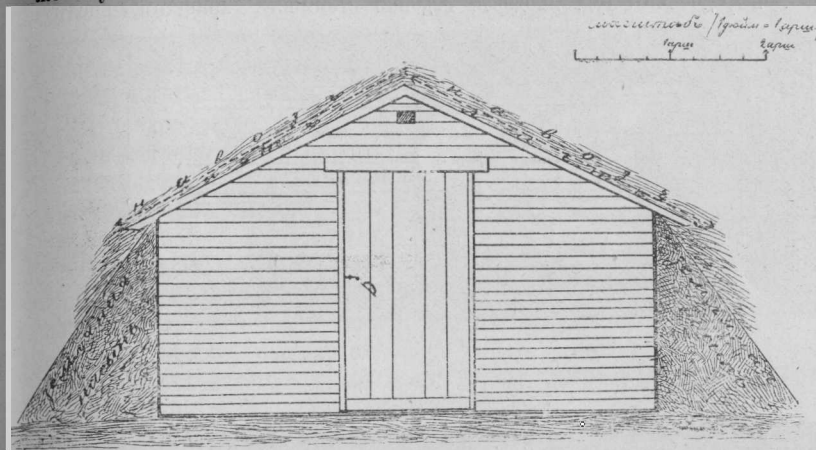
Фасадъ надземнаго плодохранилища г. Трусова.
